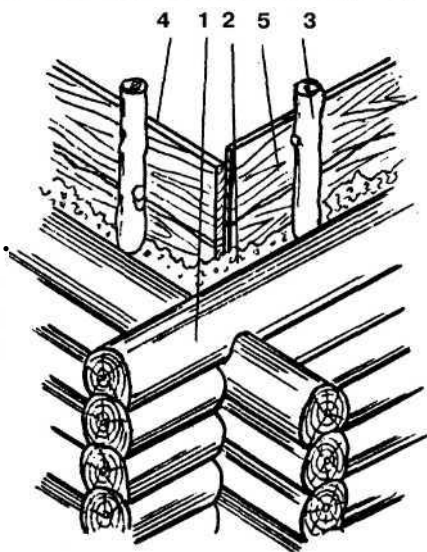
Формирование углового фрагмента бревенчатой стены:
